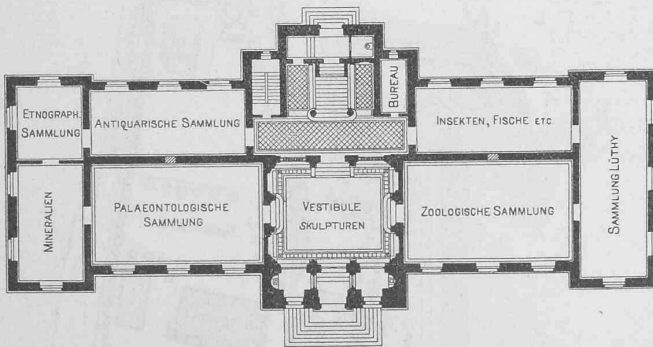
Grundriss vom Erdgeschoss. — Masstab 1:600.
